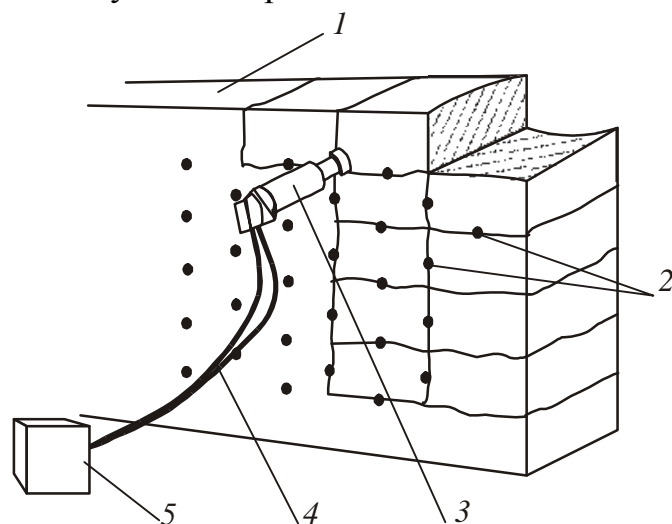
Разрушение конструкций с помощью гидравлического расклинивающего устройства: 1 – разрушаемая конструкция; 2 – шпур; 3 – расклинивающее устройство; 4 – шланги высокого давления; 5 – агрегат высокого давления
